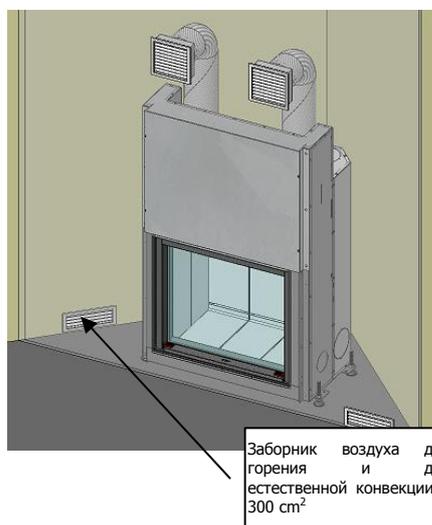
Внешний заборник воздуха для горения и для естественной вентиляции
